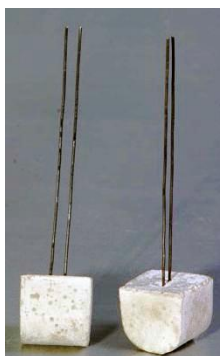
Espaçadores de betão pré-fabricados (<http://www.jacp.com.br>)
